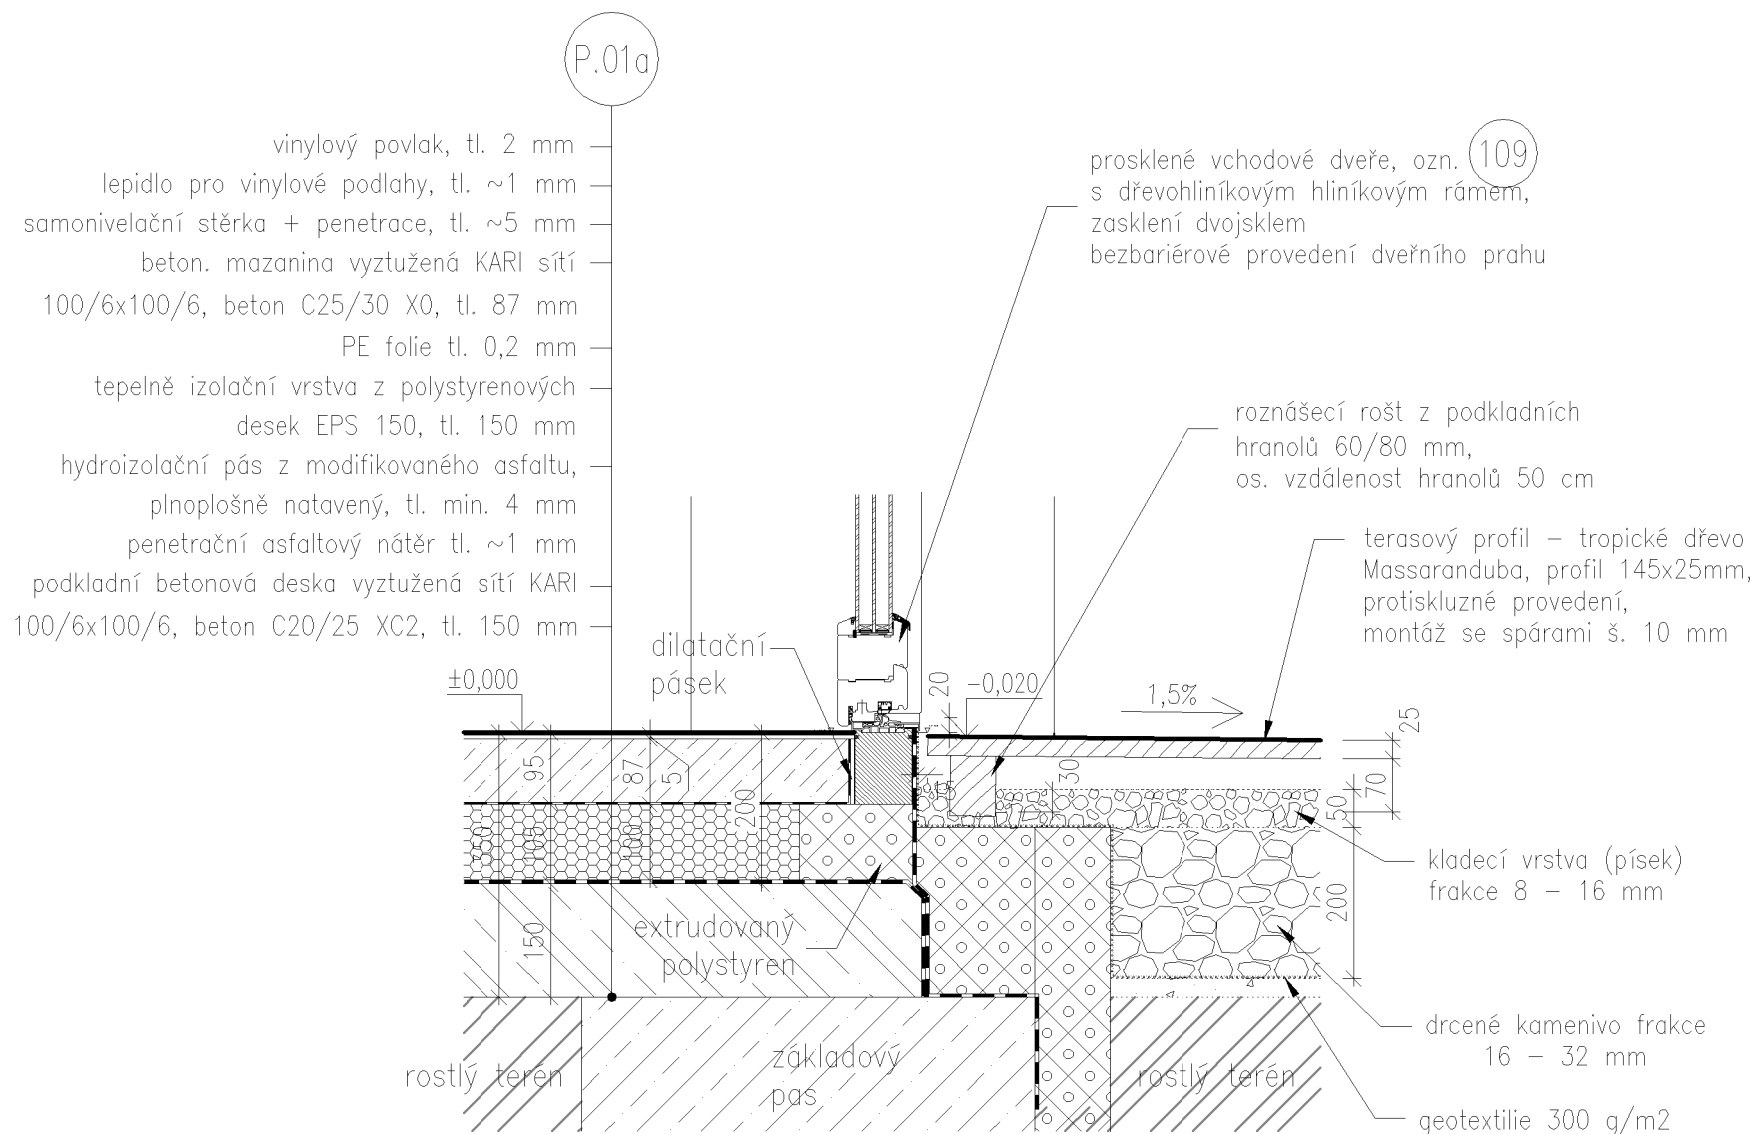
detail soklu u vyrovnávací rampy - sokl zateplený / průběžný
